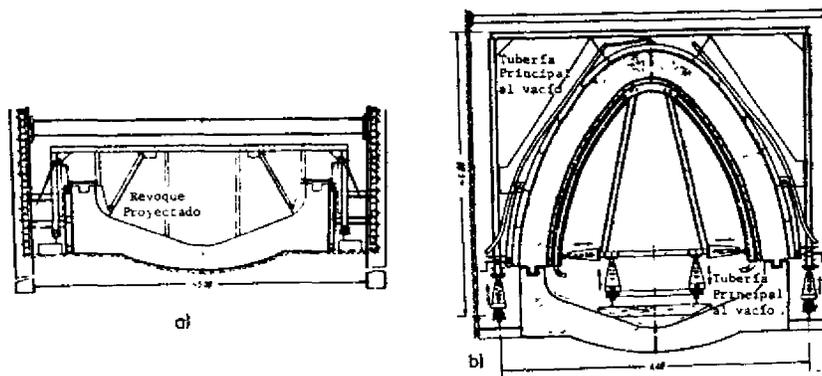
19: Construcción de alcantarillas con encofrado móvil /1/
